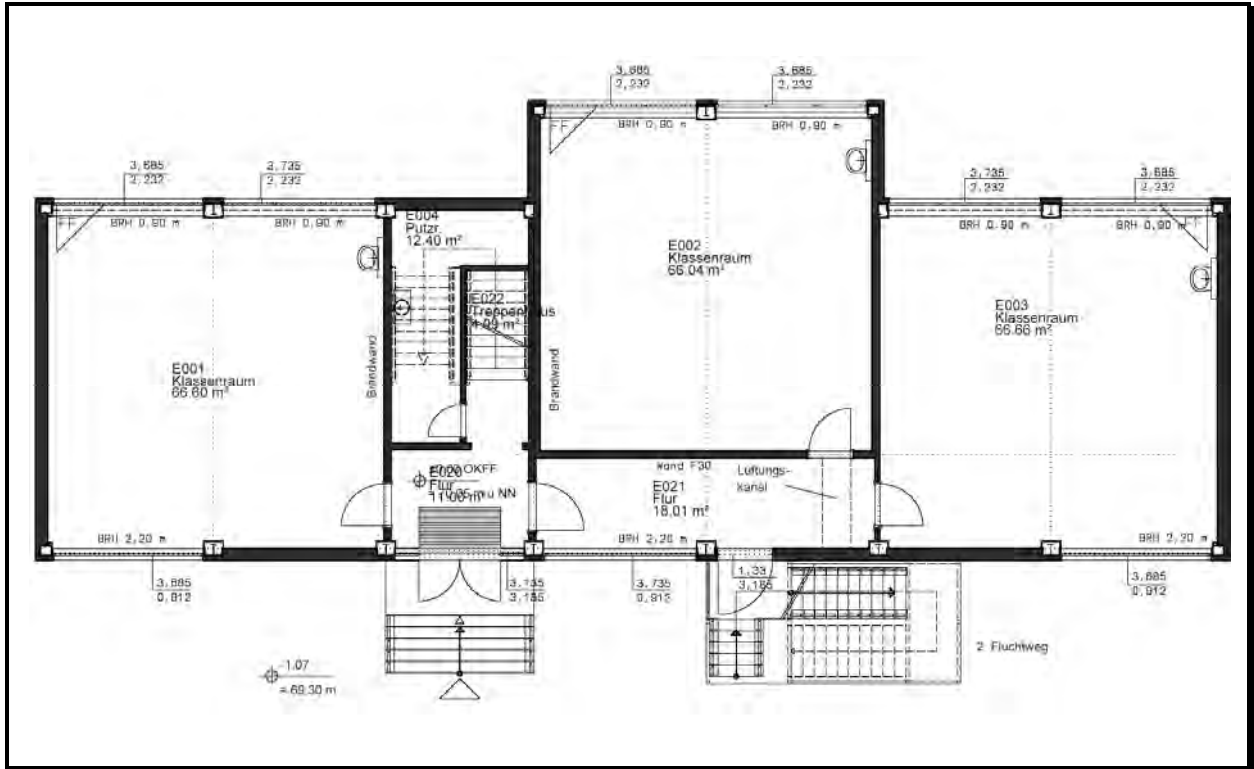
Ernst-Mach-Gymnasium: Grundriss EG Bauteil E
